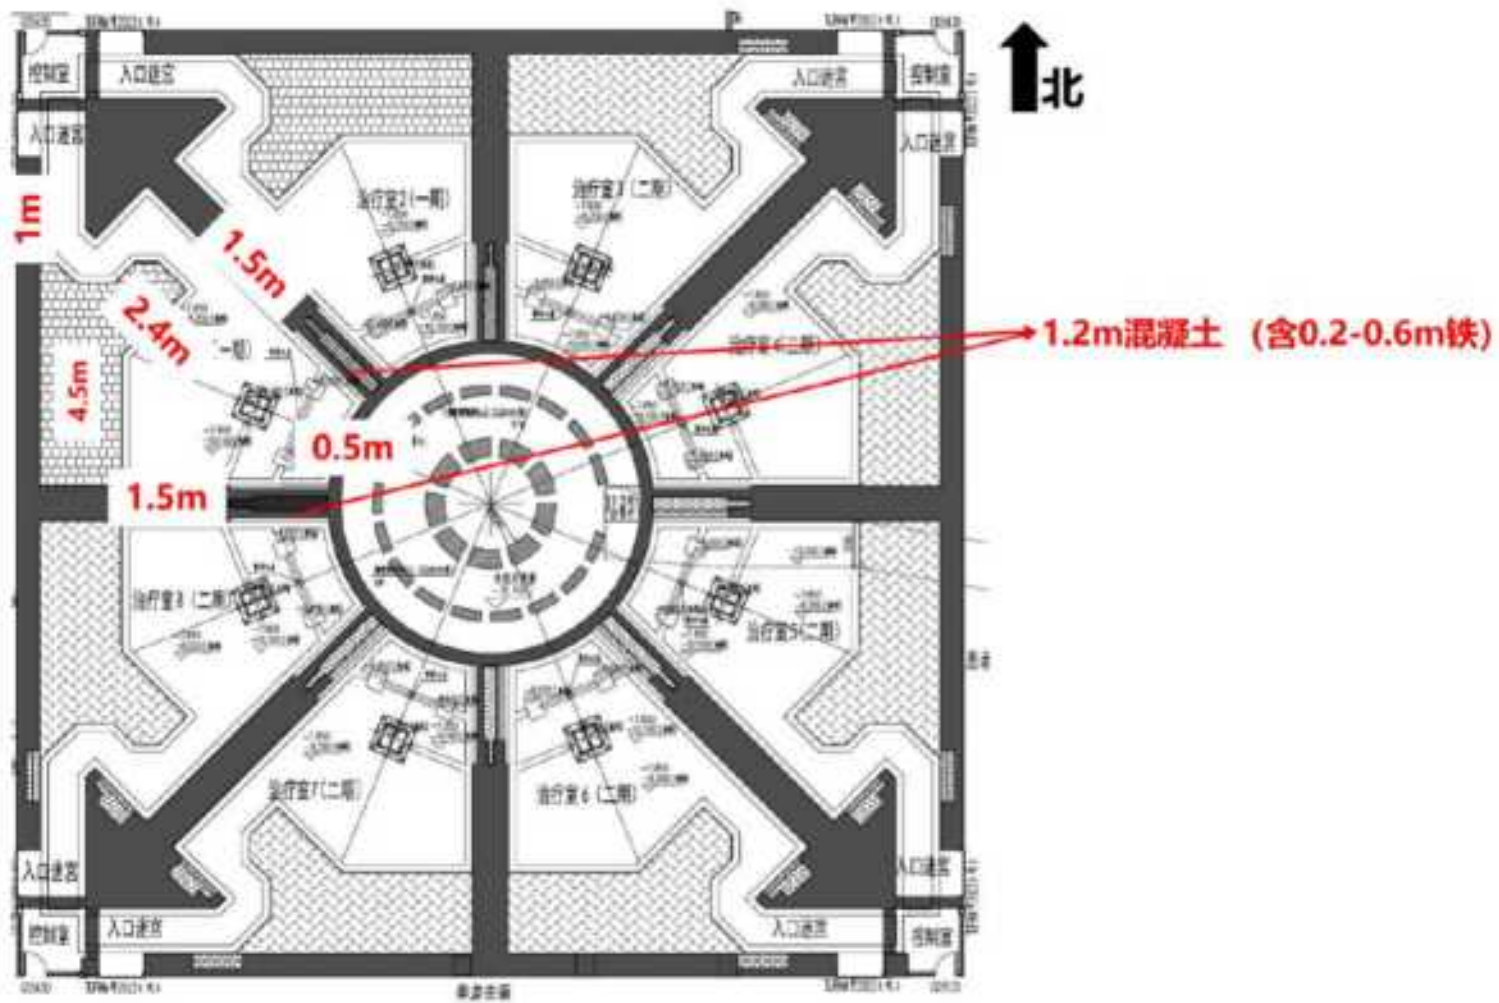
惠州重离子医学中心项目地下一层屏蔽结构平面示意图
